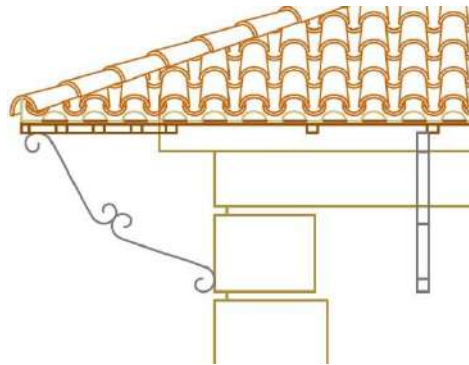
Detalle en CAD del Herraje. 2016. Fuente Propia
